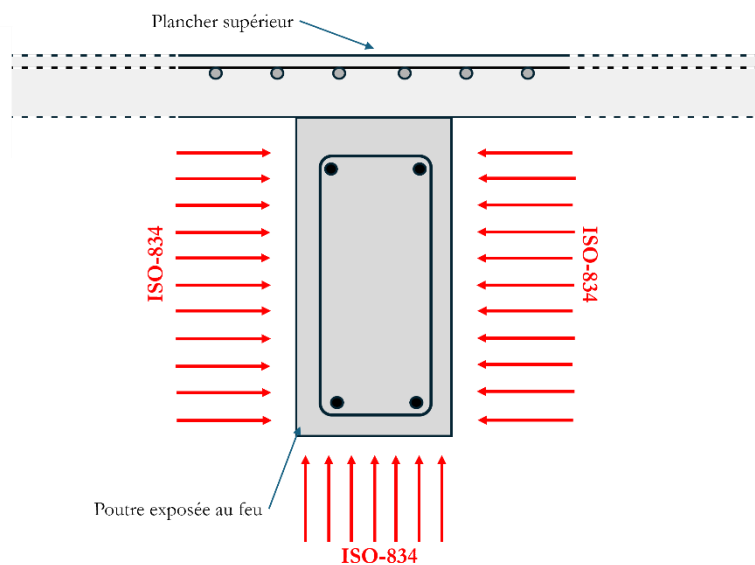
Schéma d'une coupe transversale d'un élément poutre en béton armé exposé à un flux thermique issu d'une évolution de température ISO-834
